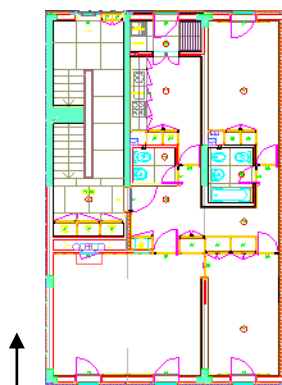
Planta com orientação base dos envidraçados (Norte – Sul)
